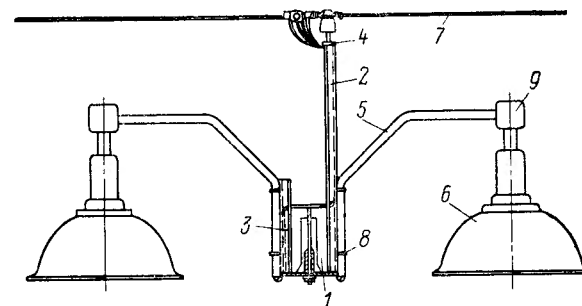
Крепление светильников и осветительной сети, выполненной проводами на изоляторах, к нижнему поясу металлической фермы.
